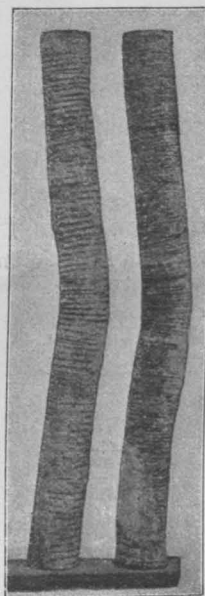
Umschnürte Betonsäulen mit zusammenhängendem Betonkern nach dem Einknicken.
